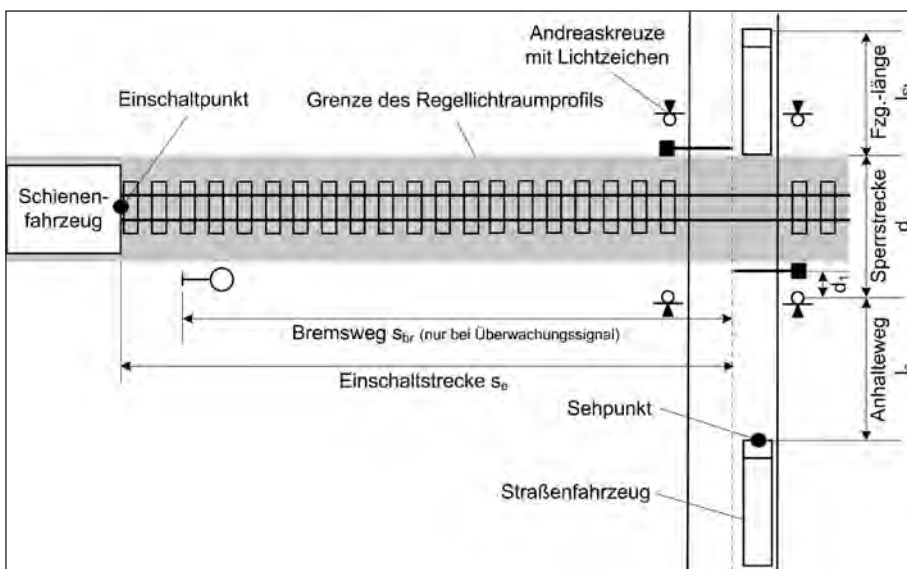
Punkte und Strecken zur Berechnung technisch gesicherter BÜ
